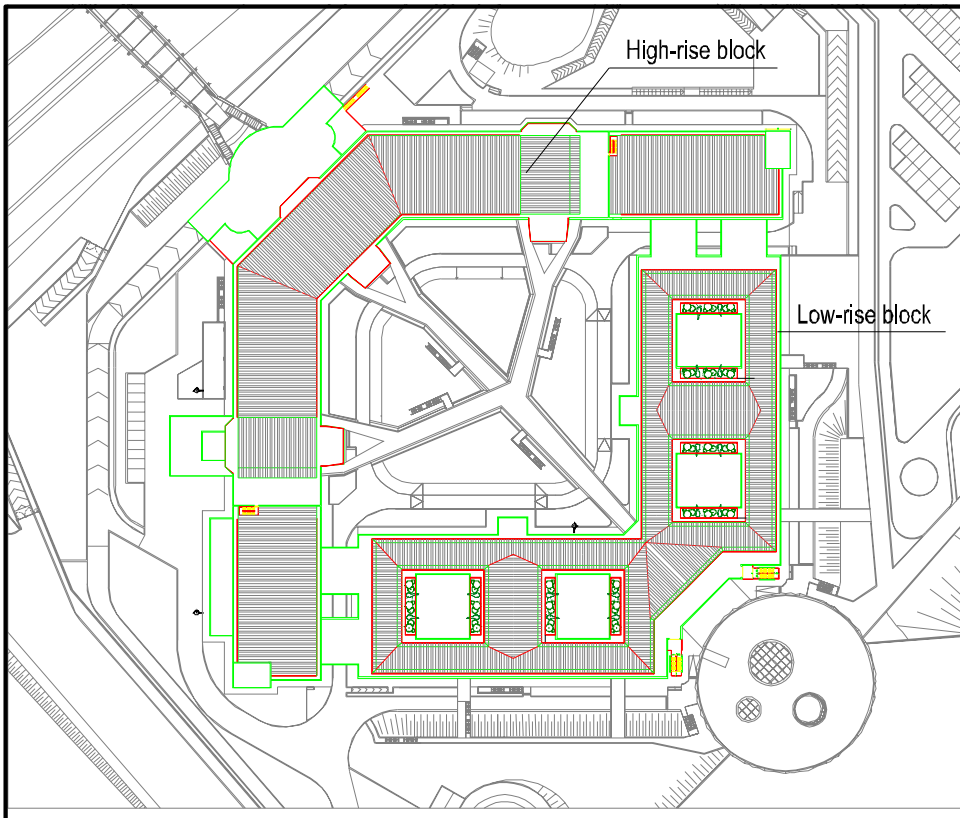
Pianta (Ospedale del Mare, Napoli).
